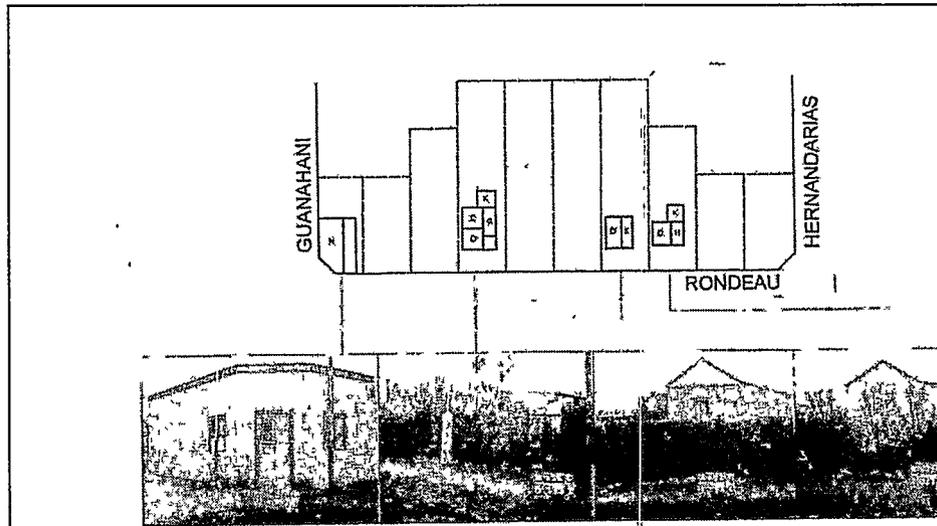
, Manzanilla 25e, parcelas 10, 11, 14 y 17. Planta y vista sobre calle Rondeau. Fuente: relevamientos catastrales, 1941, Municipalidad de General Pueyrredón.
